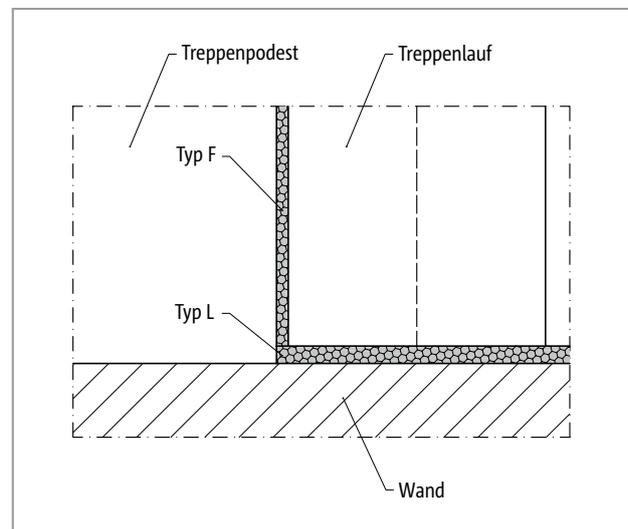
Schöck Tronsole® Typ F: Elementanordnung, Detail B
